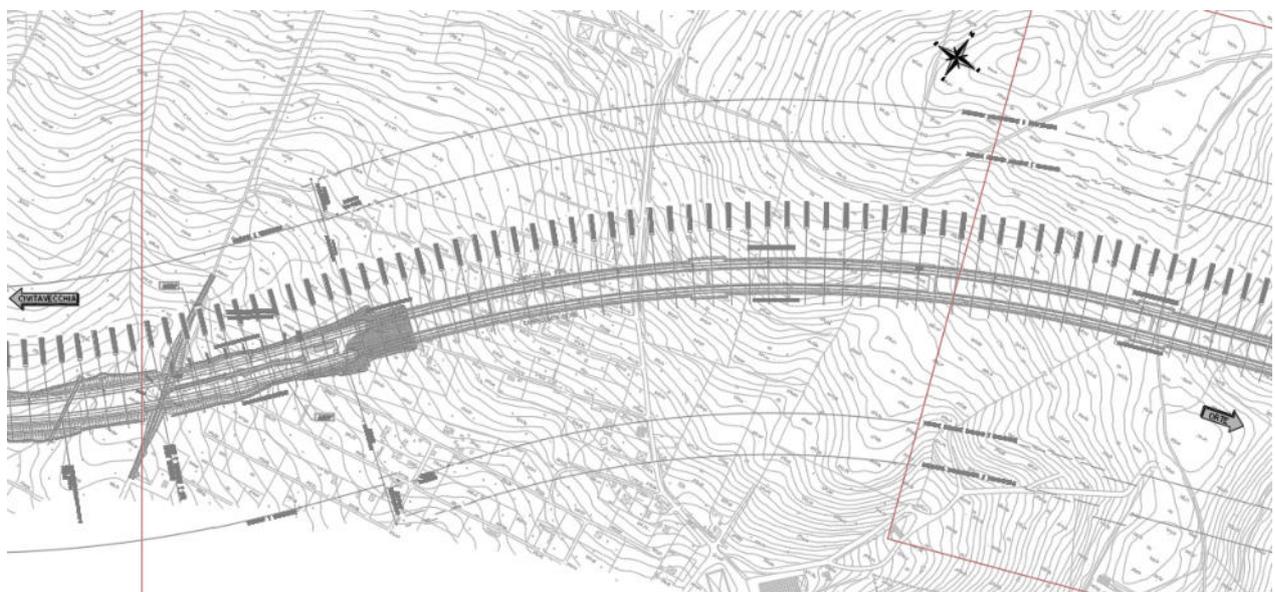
Stralcio planimetria fine galleria Monteromano (L=1566,30m)
